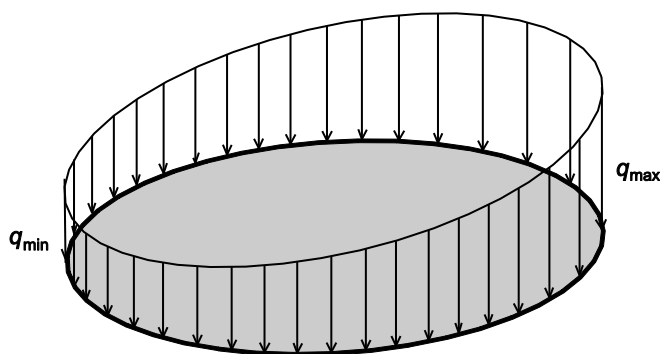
Нагрузки на фундаментное кольцо резервуара
